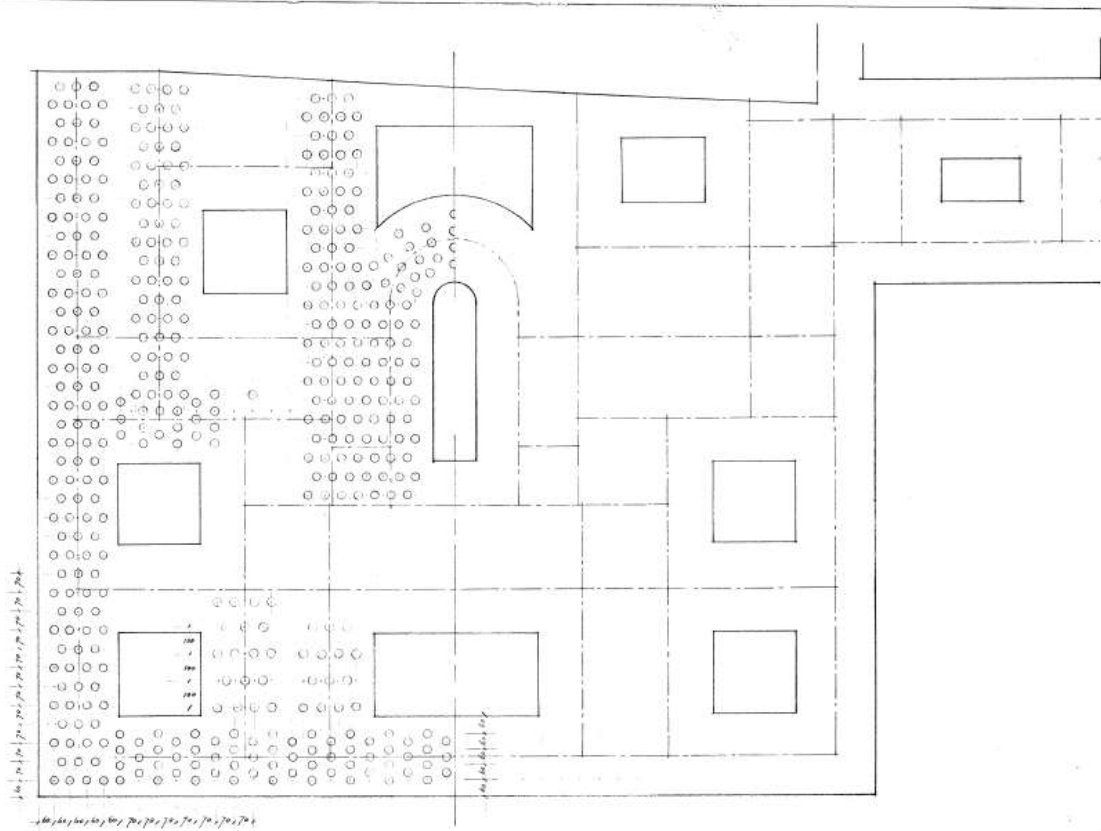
Pianta della palificata sotto al fabbricato in esame (progetto preliminare).
